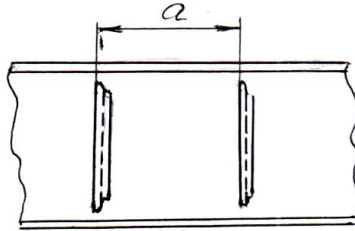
Подкрепление рамной связи вертикальными ребрами
